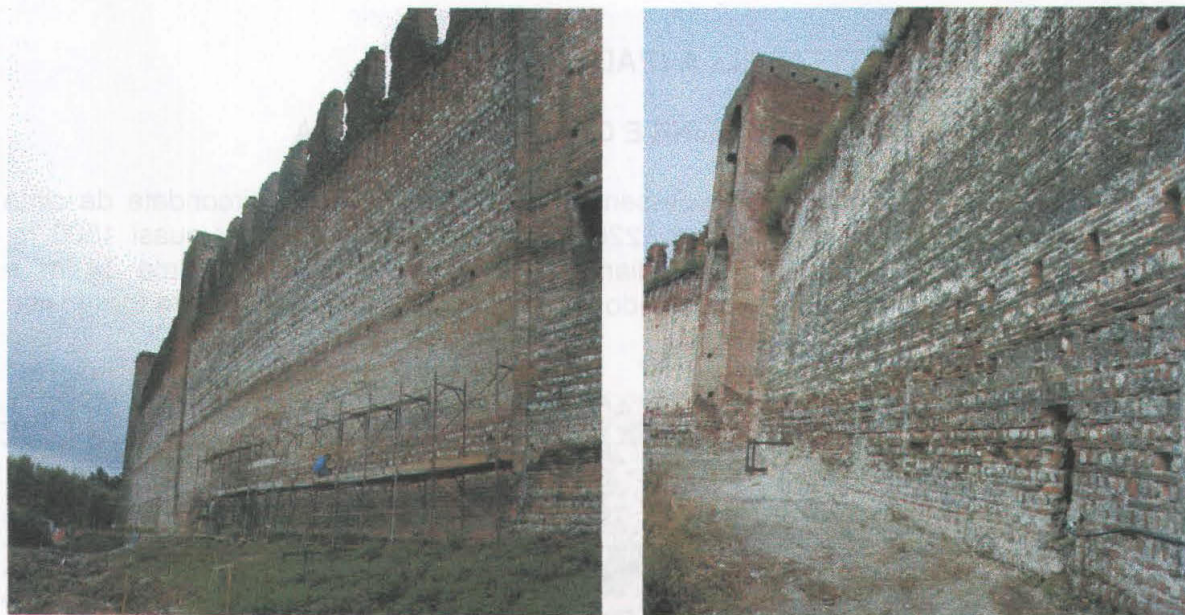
Zona d'indagine: vista dall'esterno e dall'interno delle mura.
